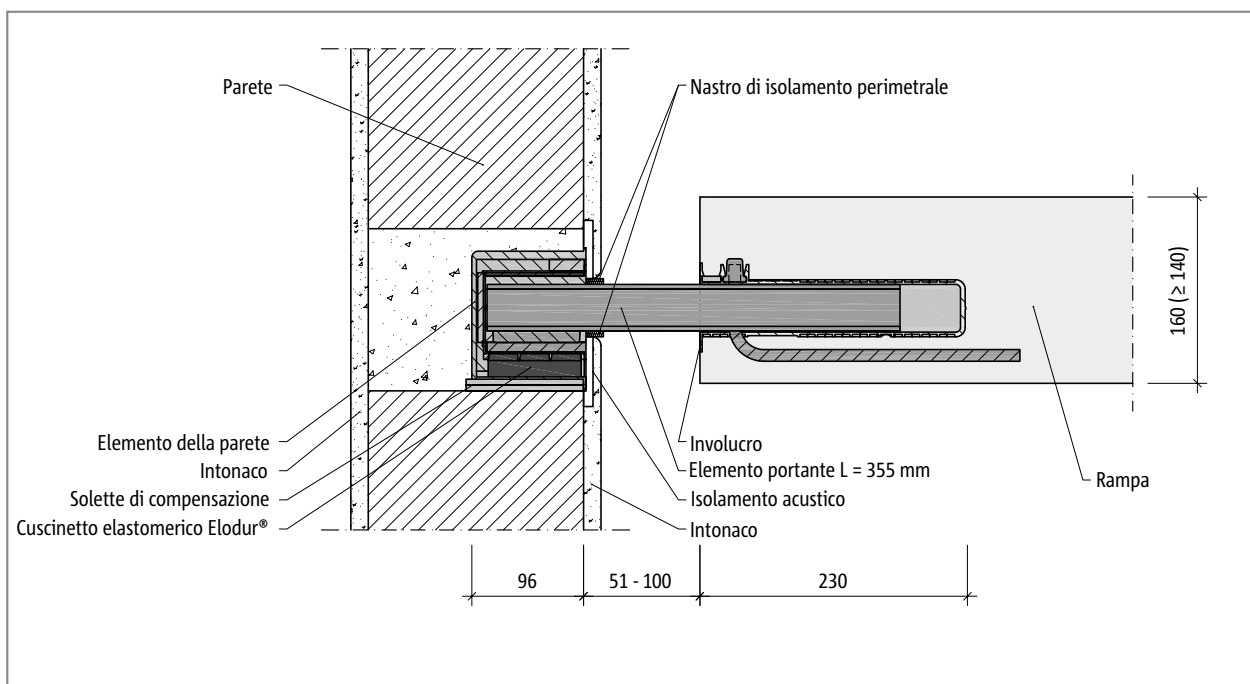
Schöck Tronsole® tipo Q-FV-XL o Q-A2-XL: sezione costruttiva - costruzione prefabbricata
